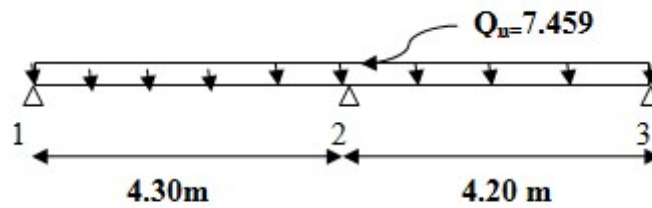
Schéma statique de calcul du 2eme type de poutrelles
